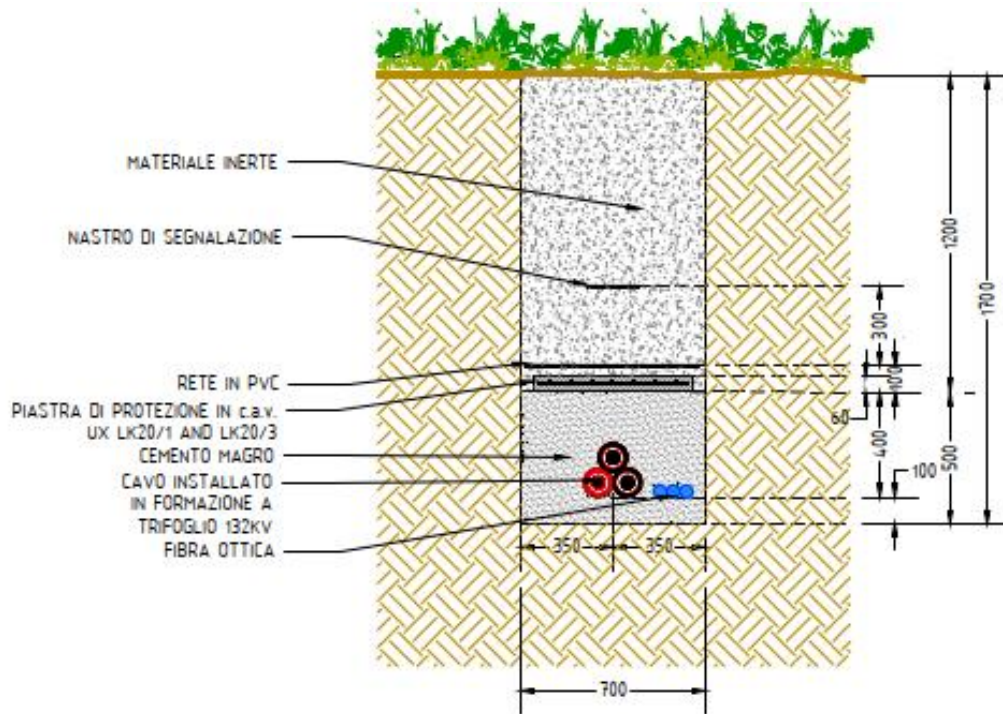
Sezione tipo su terreno - Tratto di cavidotto dalla Stazione di Trasformazione alla Stazione di Connessione.
